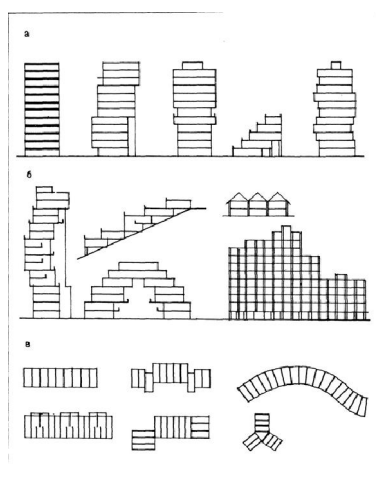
Варіант об'ємної побудови будівлі з поперечними несучими стінами
